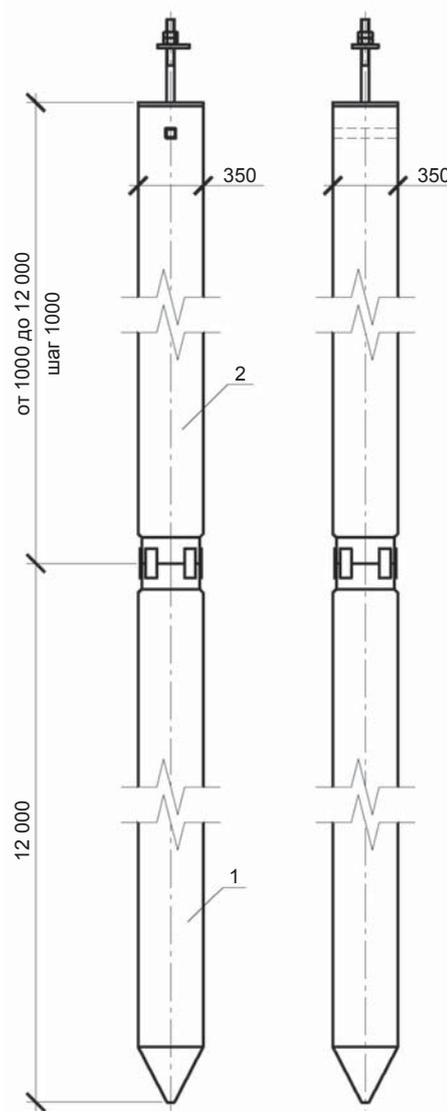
Схема составных электротехнических свай (1 — нижняя секция сваи; 2 — верхняя секция сваи)
